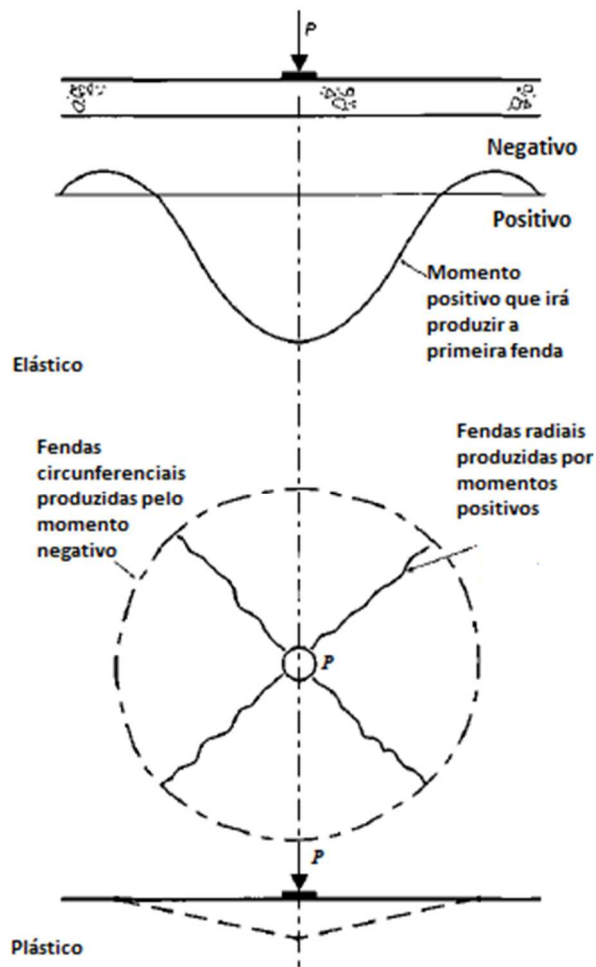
Desenvolvimento de fendas radiais e circulares numa laje de pavimento térreo interna
